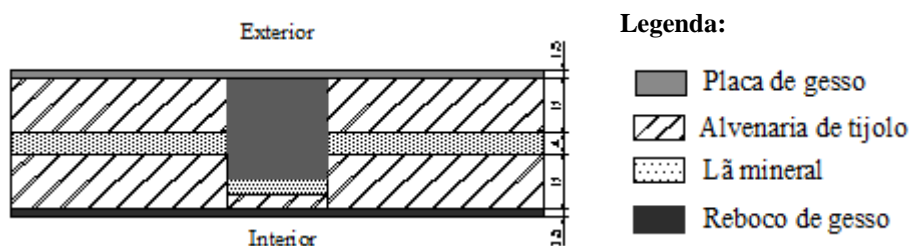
Pormenor construtivo do pilar na parede em contacto com zona comum revestido com lã mineral
